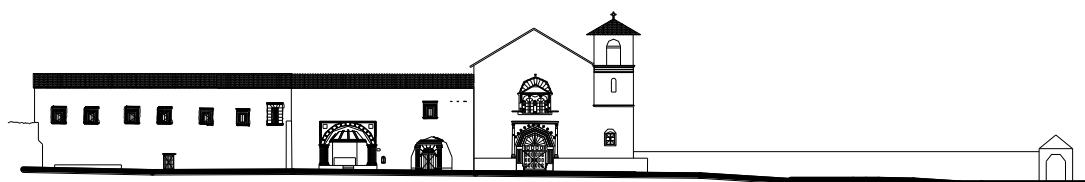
Reconstrucción hipotética de la fachada oriente del convento y templo construidos a finales del siglo XVII por fray Pedro de Pila. Elaboración propia con base en AHCM, “secularización”...
